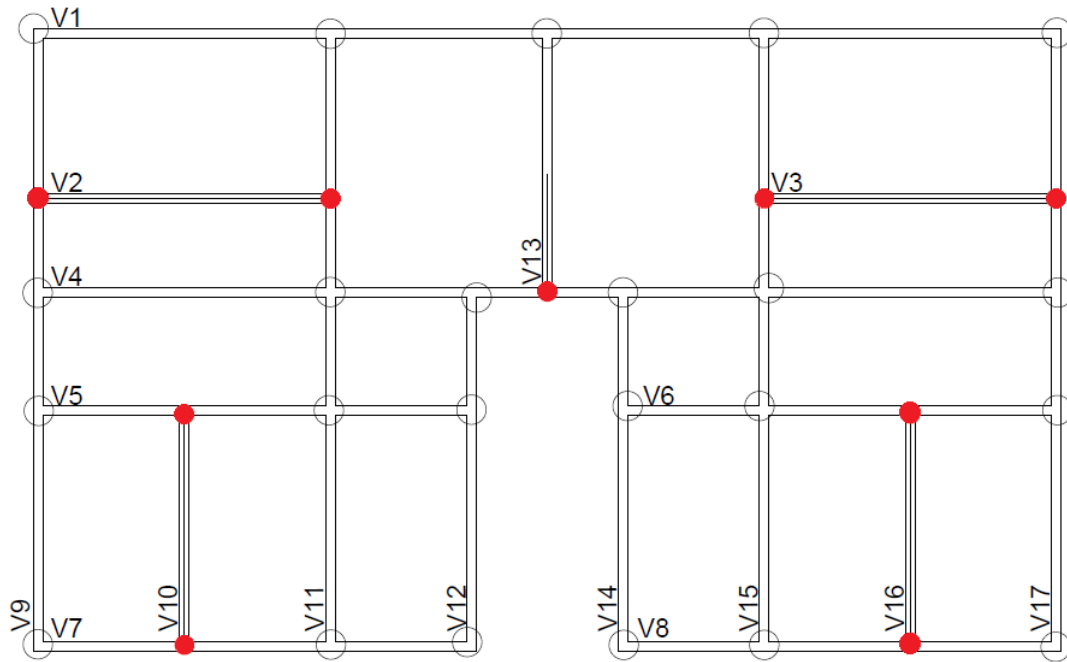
Identificação das vigas a serem apoiadas em outras vigas
